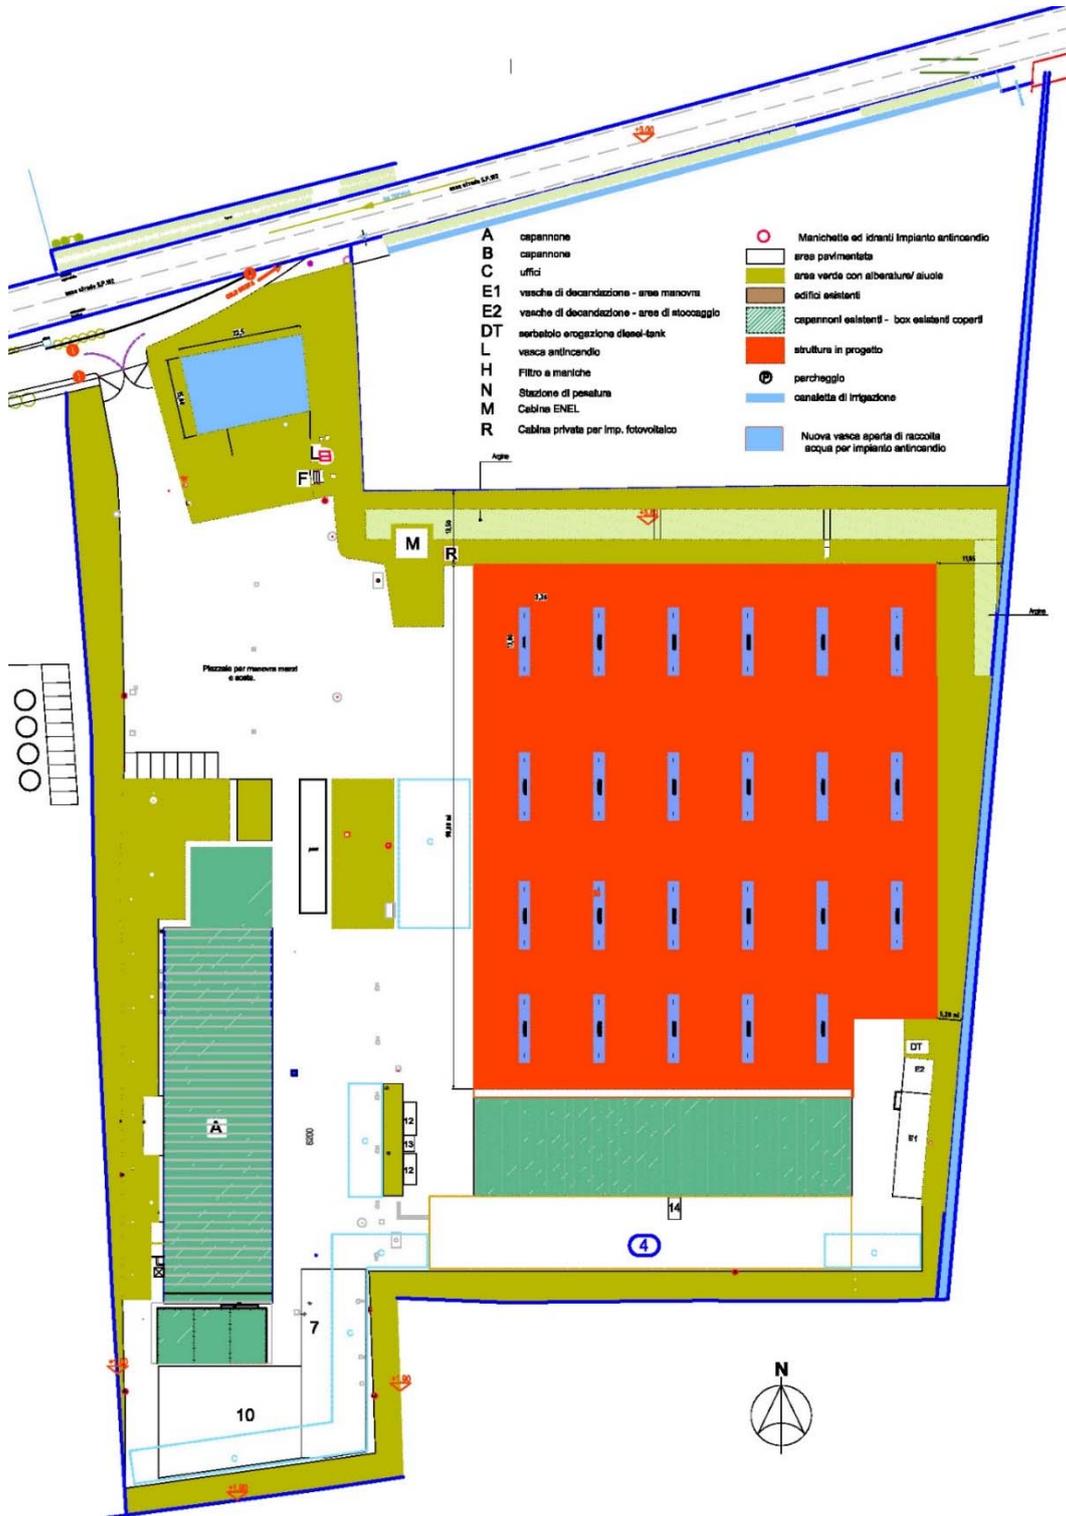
Planimetria di progetto con ubicazione del nuovo Capannone D
